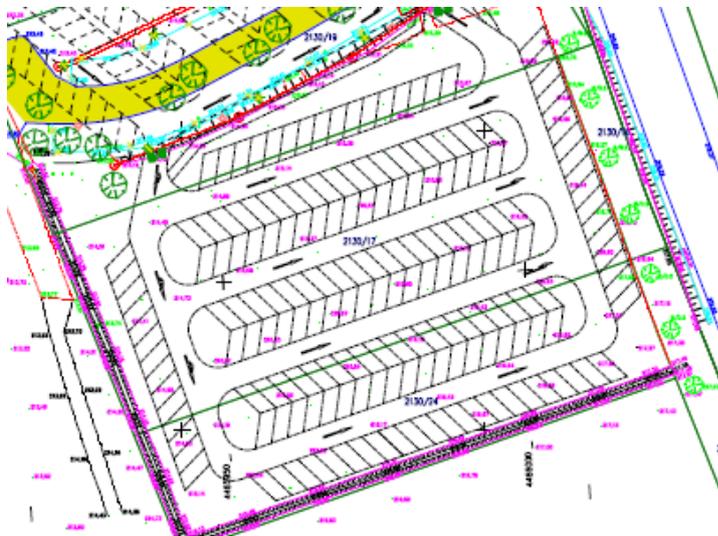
Lageplan Parkplatz (Ausschnitt aus der Vorplanung mit möglicher Stellplatzanordnung) - unmaßstäblich (Entwurf: i.P.i. – Stand: 10.2018)
